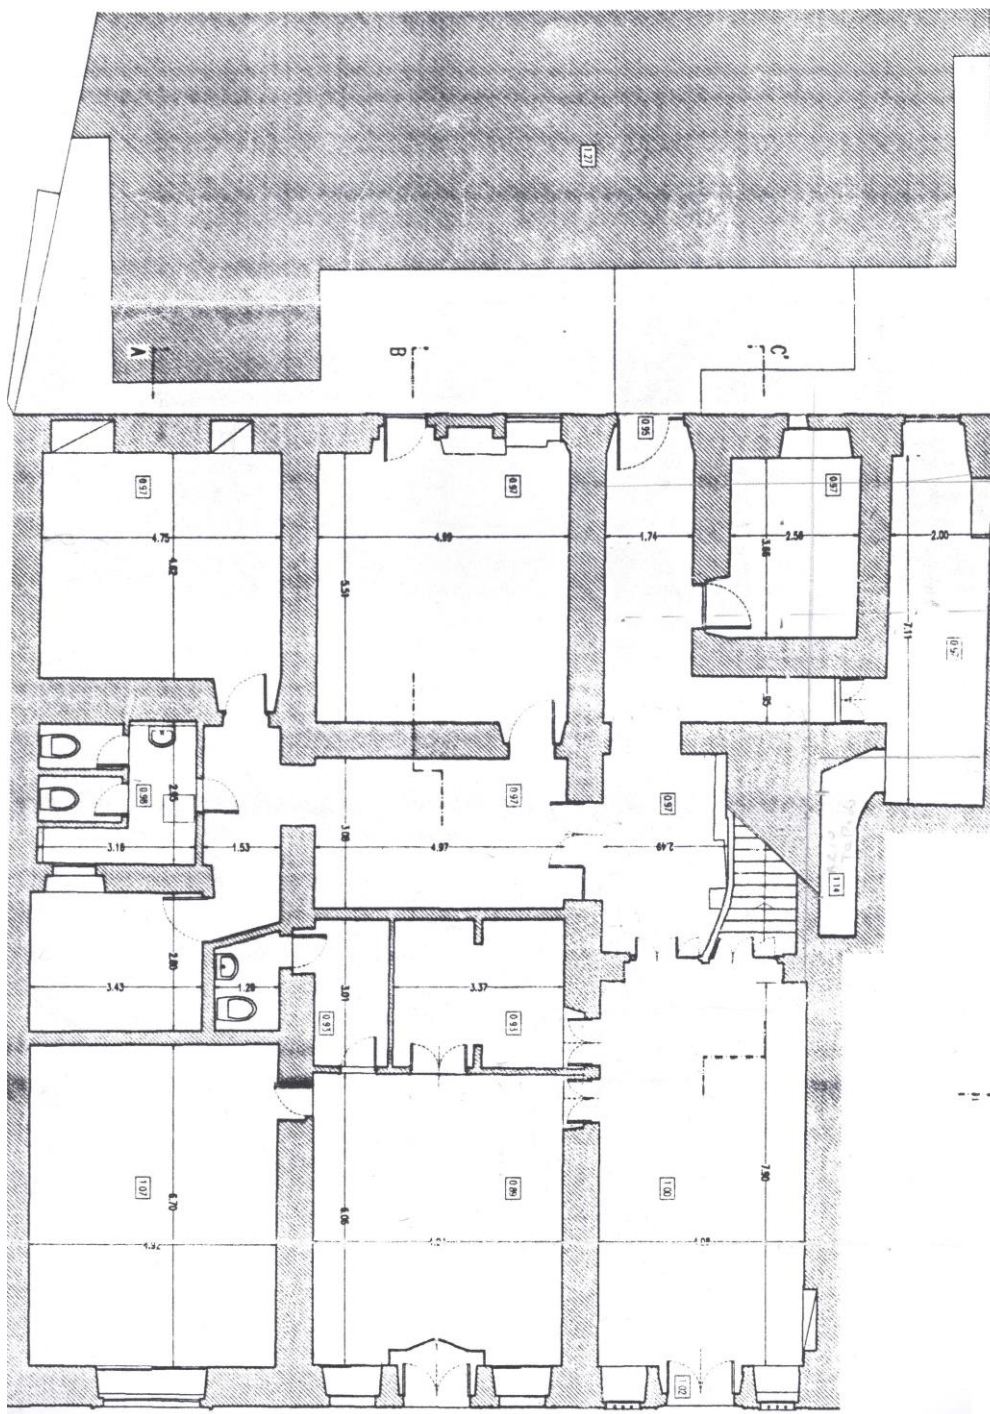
Planta do piso 0 do palacete. (PINTO, 2005, Anexo I)
